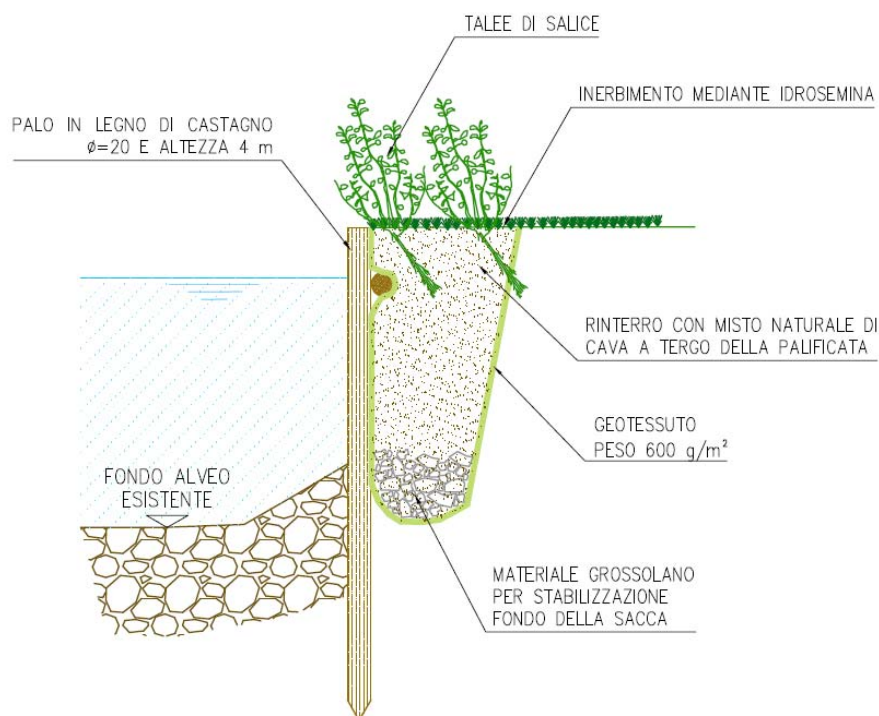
Particolare costruttivo dell'intervento di stabilizzazione di sponda
